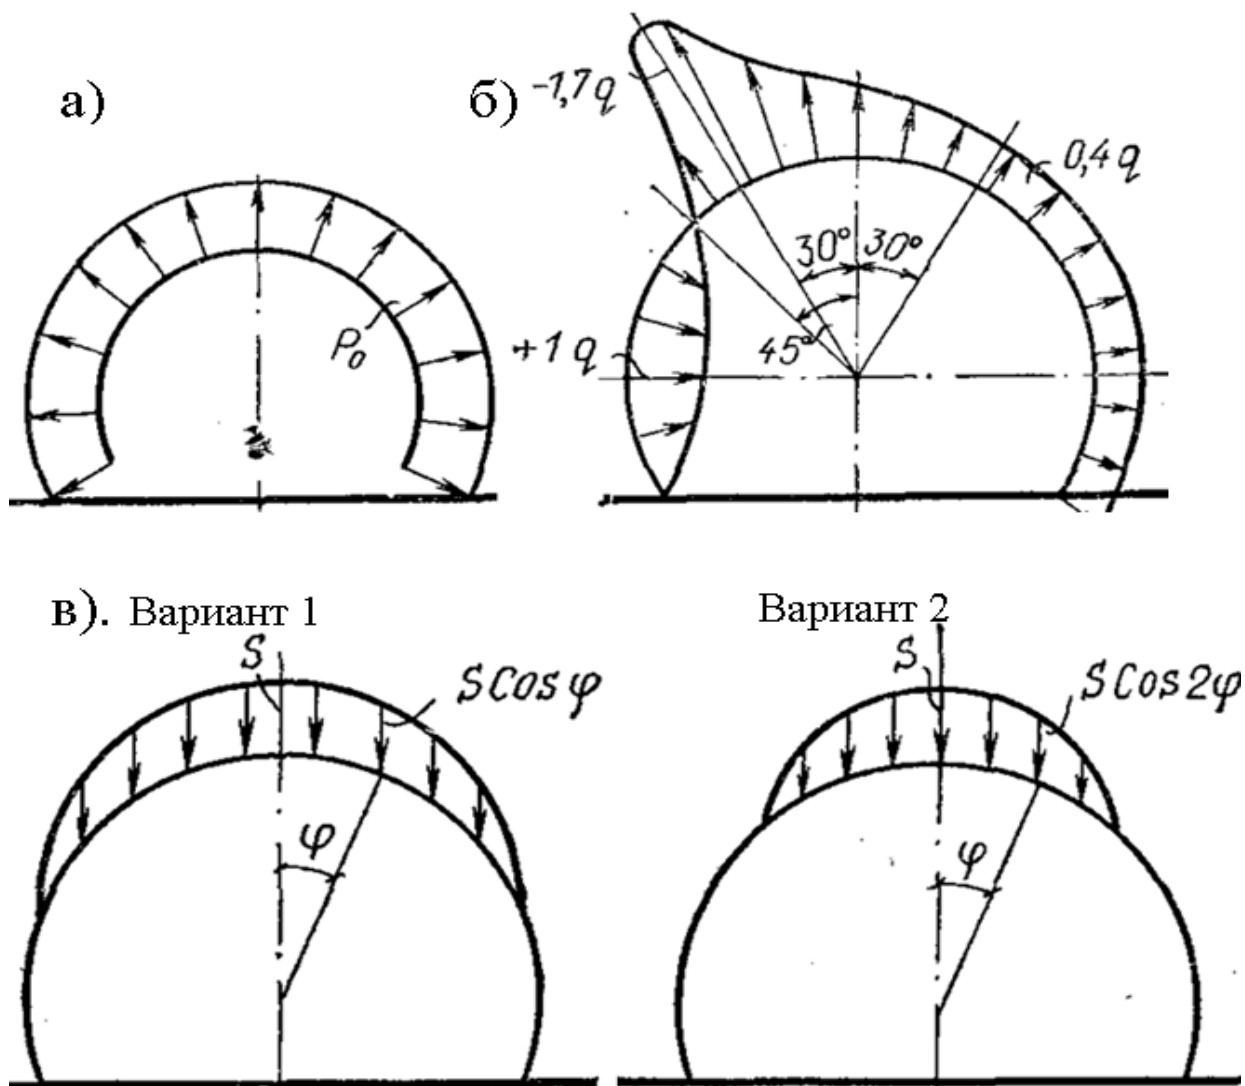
Нагрузки на пневматическую конструкцию: а – избыточное давление, б – ветровая нагрузка, в – снеговая нагрузка.
